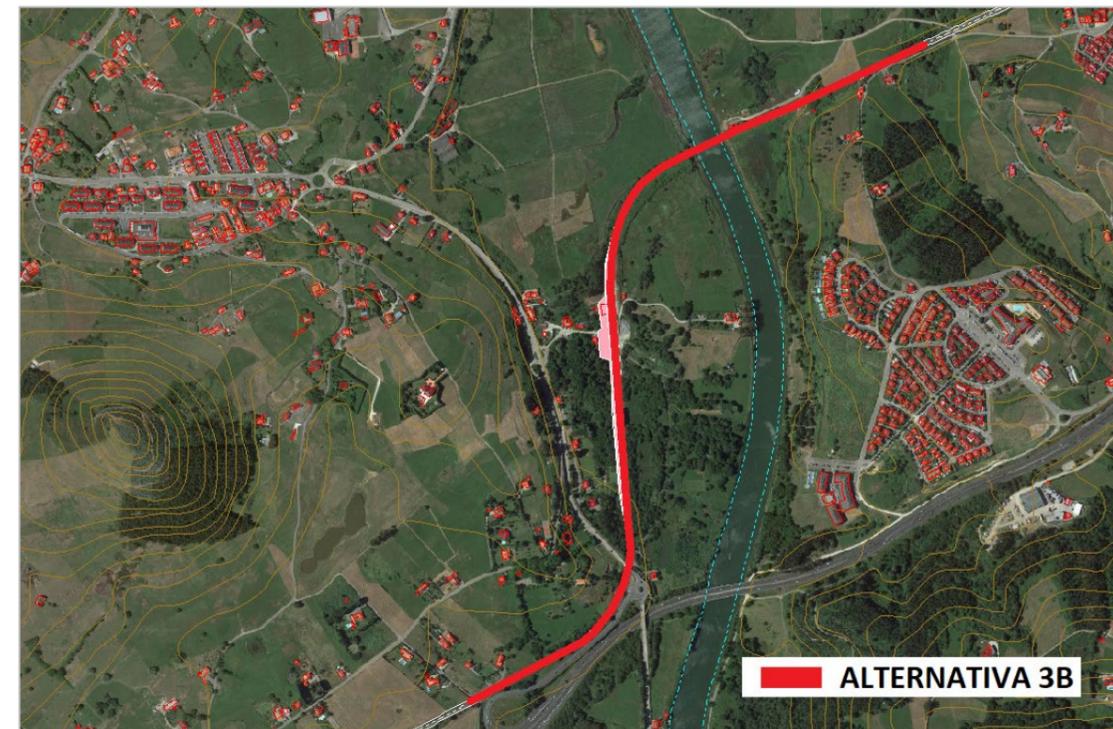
Trazado en planta de la alternativa 3B. Fuente: Istram
